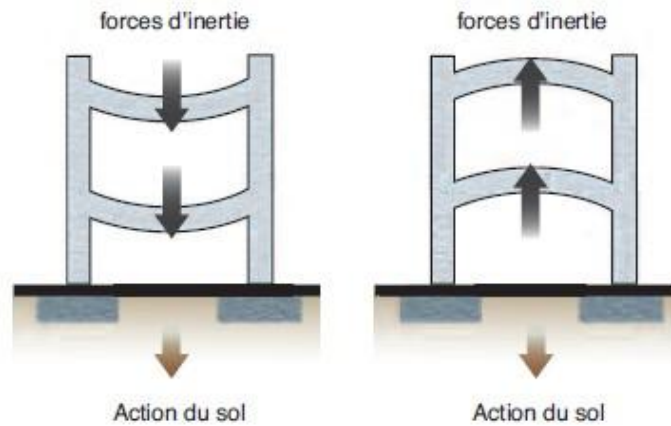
Réponse d'un bâtiment au séisme vertical (extrait Cimbeton – Béton et construction parasismique - 2009)
